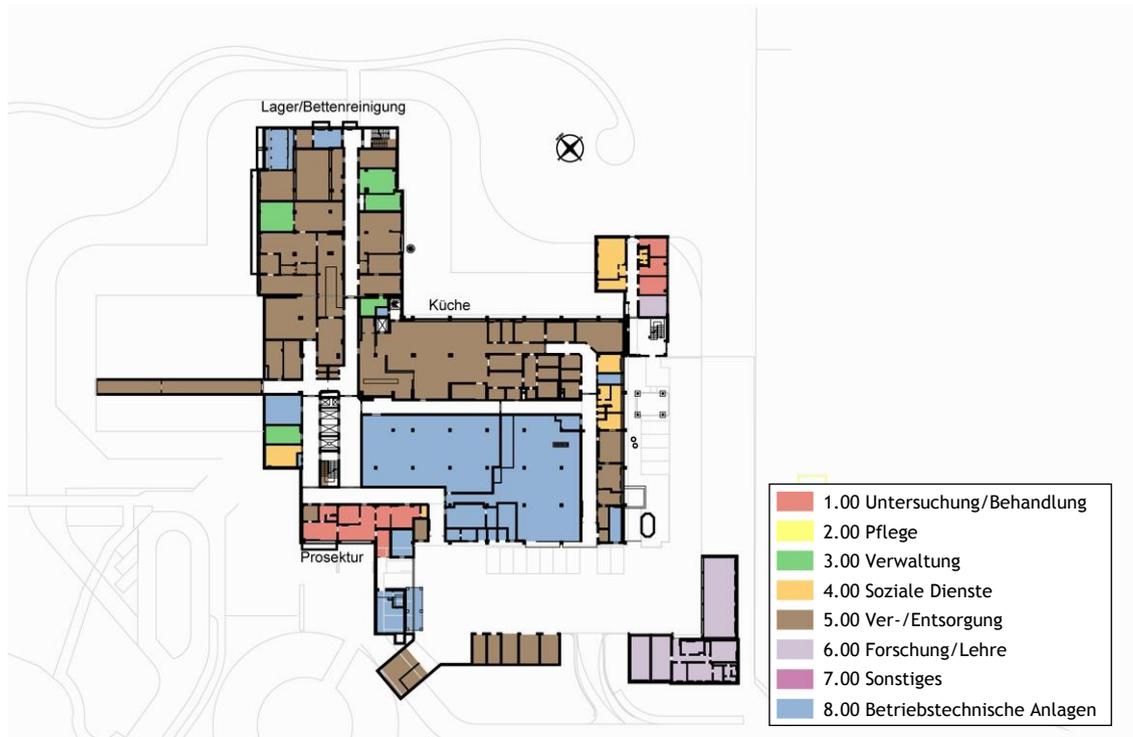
IST-Flächen nach DIN 13080 - 1.Untergeschoss
